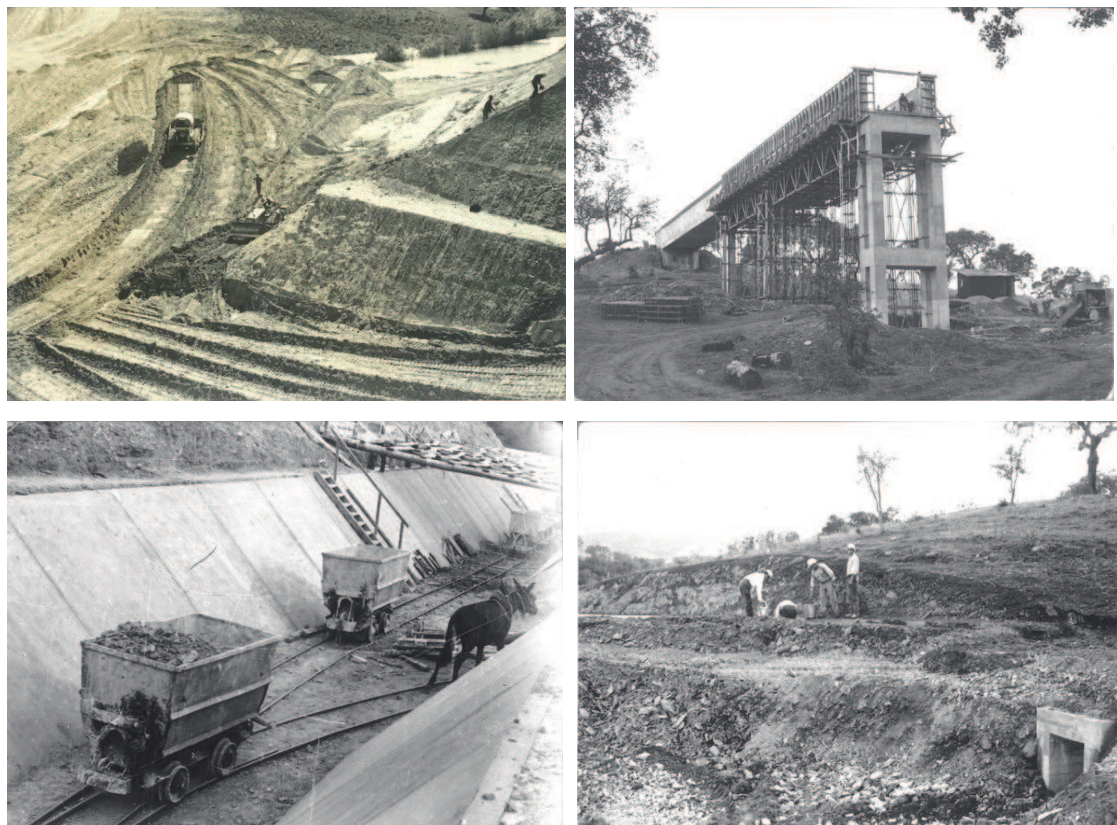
Construção da Barragem do Mira (fonte: www.abm.pt)
